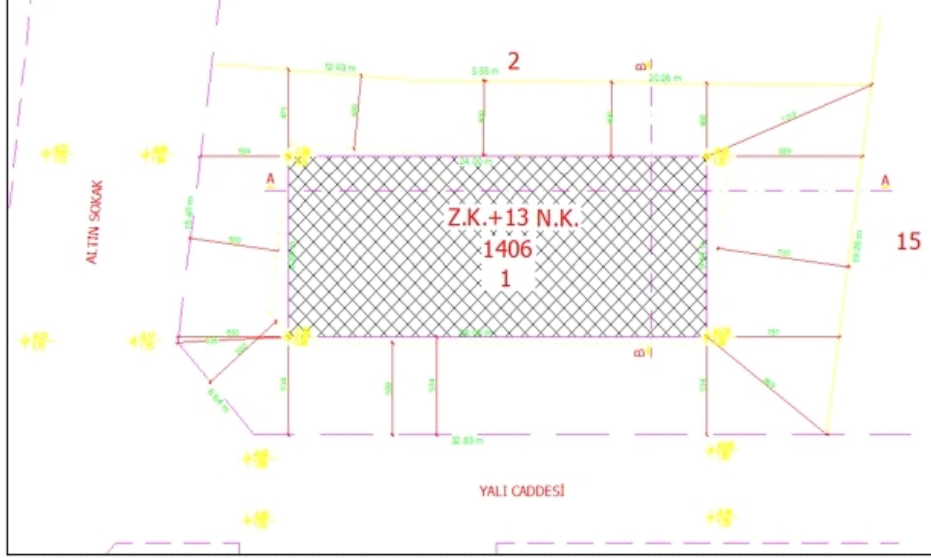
İyileştirme Uygulanacak Yapı Vaziyet Planı	4
